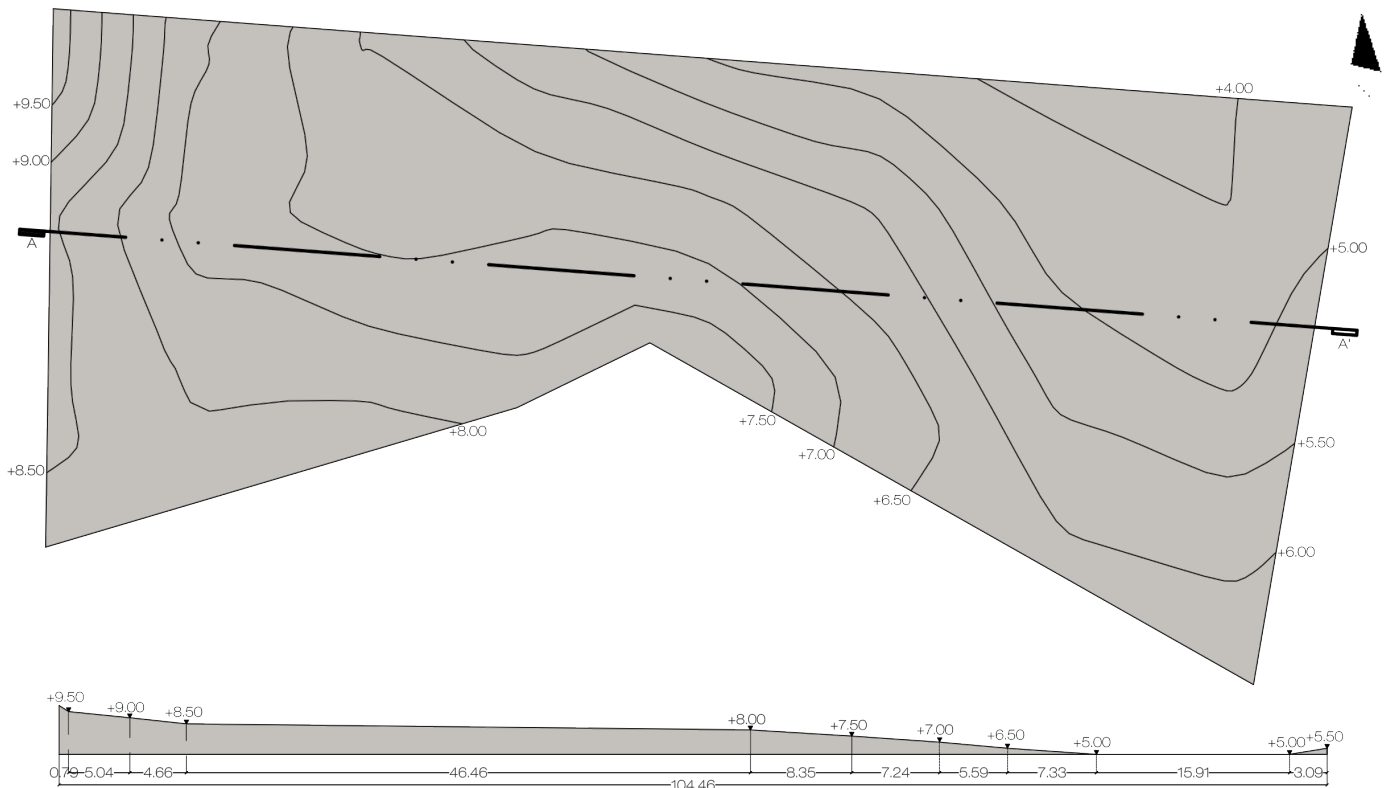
Plano topográfico. Ilustración elaborada por autor.
